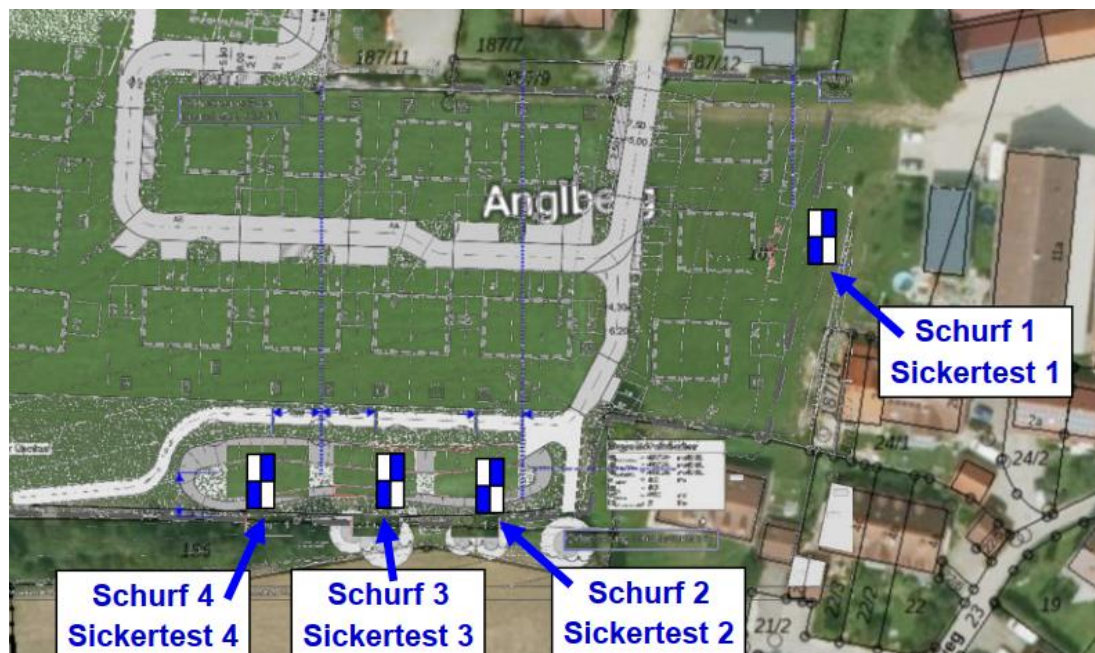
Lageplan Baggerschürfe und Sickerversuche
